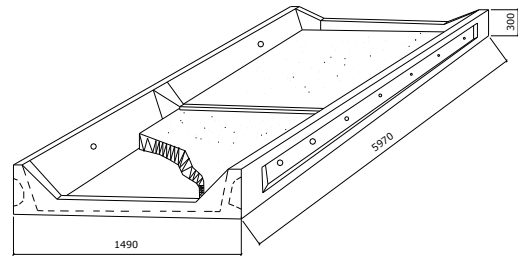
Комплексна керамзитобетонна попередньонапружена плита з ребрами догори
